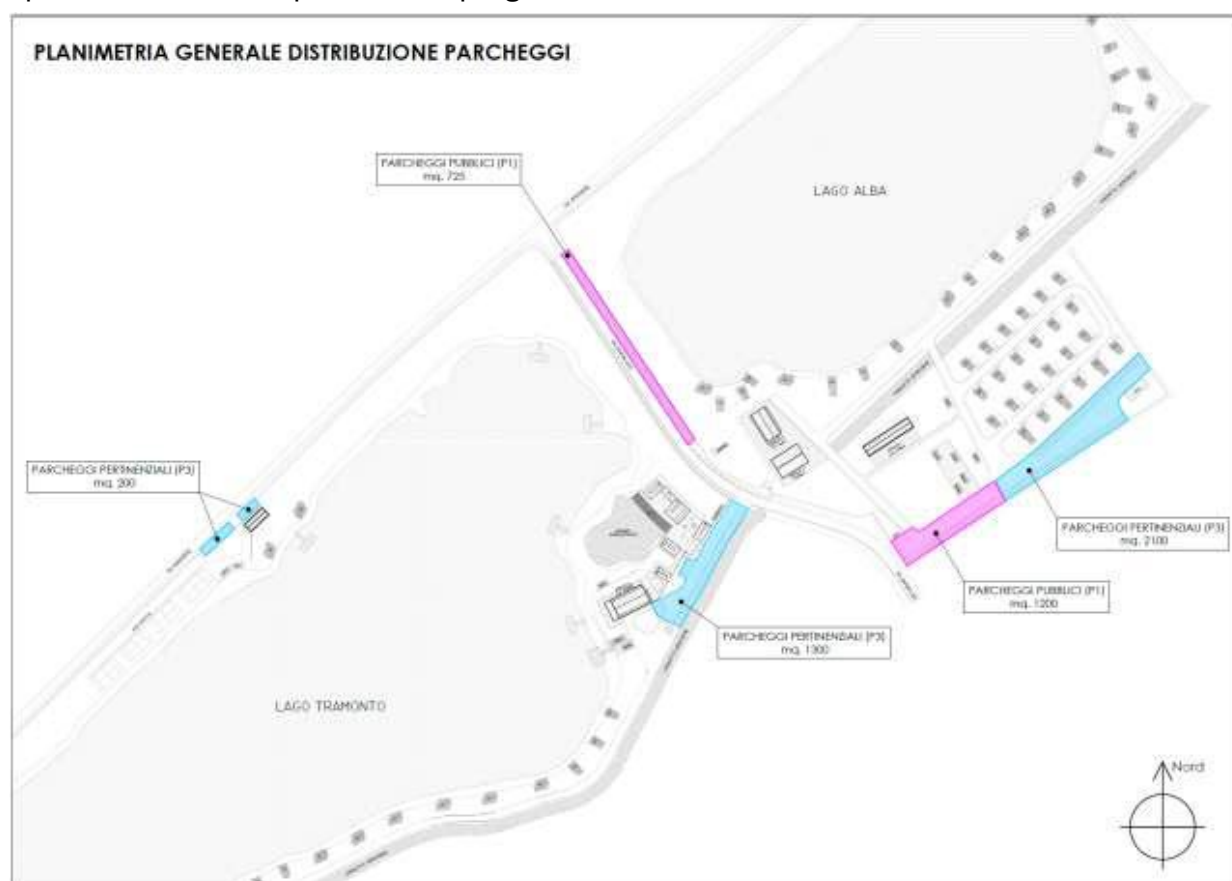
Planimetria generale della distribuzione dei parcheggi (stato di progetto).
